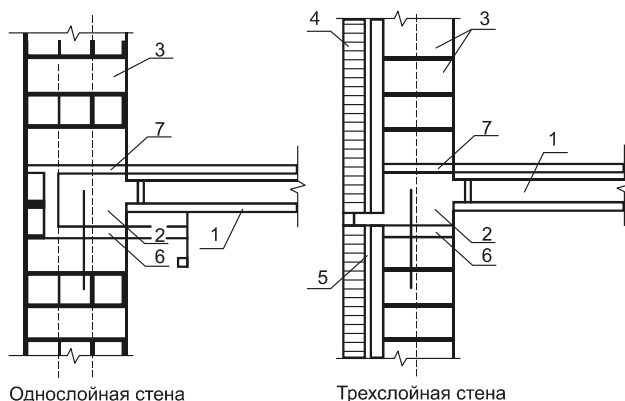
Узлы: 1 — сборные многпустотные плиты перекрытия; 2 — крайний монолитный ригель; 3 — кладка из ячеистобетонных камней; 4 — облицовочный слой кладки; 5 — утеплитель; 6 — компенсационная прокладка (пенополистирол); 7 — раствор
